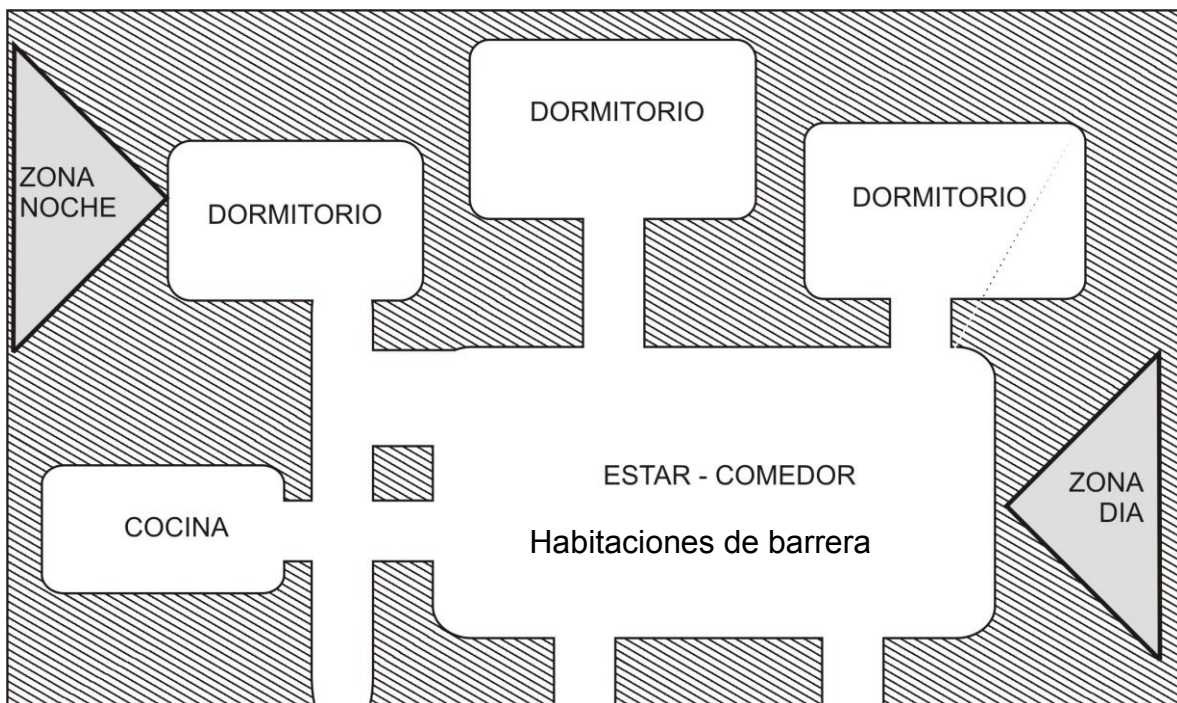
Vista en planta de la distribución de una casa de excavación horizontal en una ladera.
